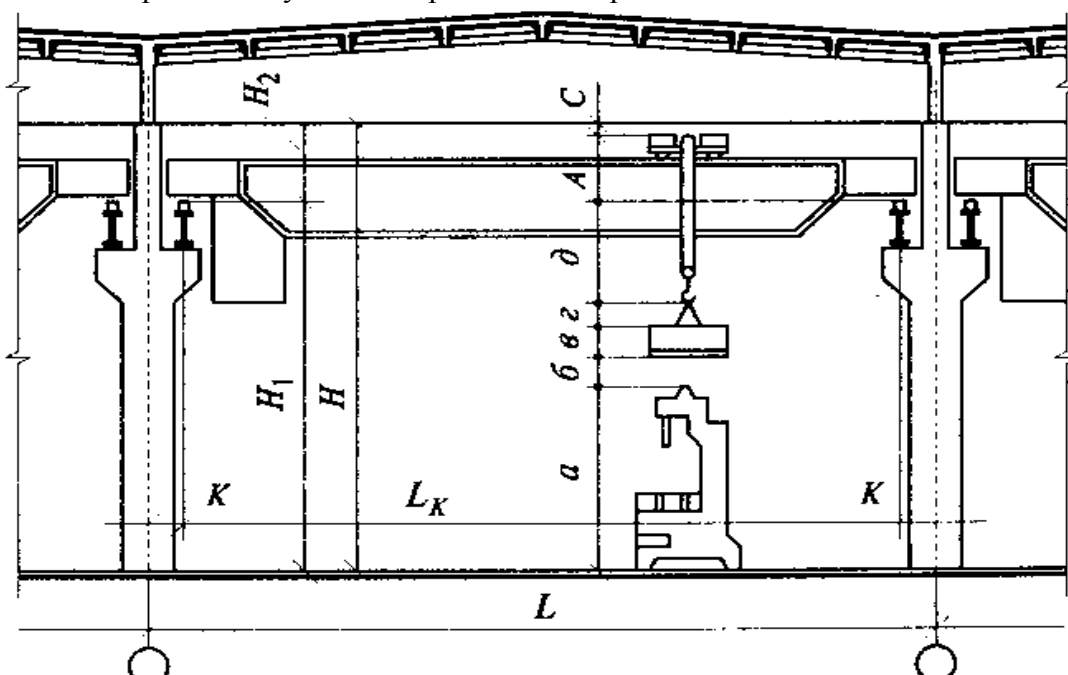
Схема разреза одноэтажного здания к определению параметров пролета
